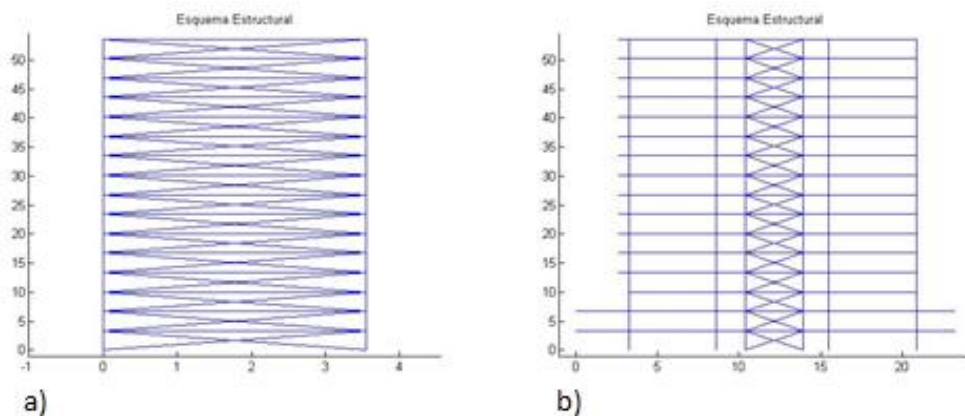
Pórticos longitudinales sin reforzamiento a) Pórtico C'; b) Pórtico D.
